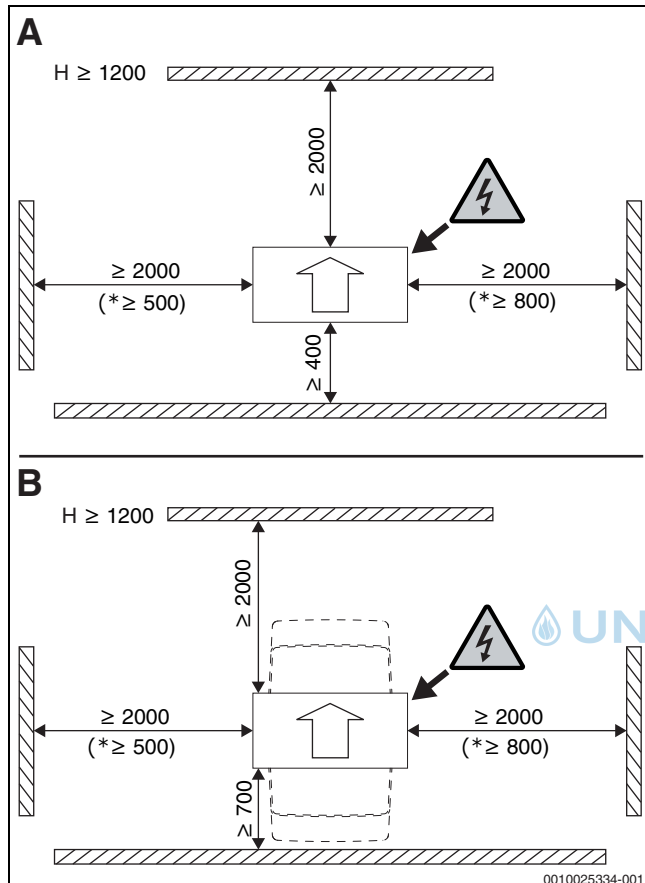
Mindestabstände der Außeneinheit (Maße in mm)
